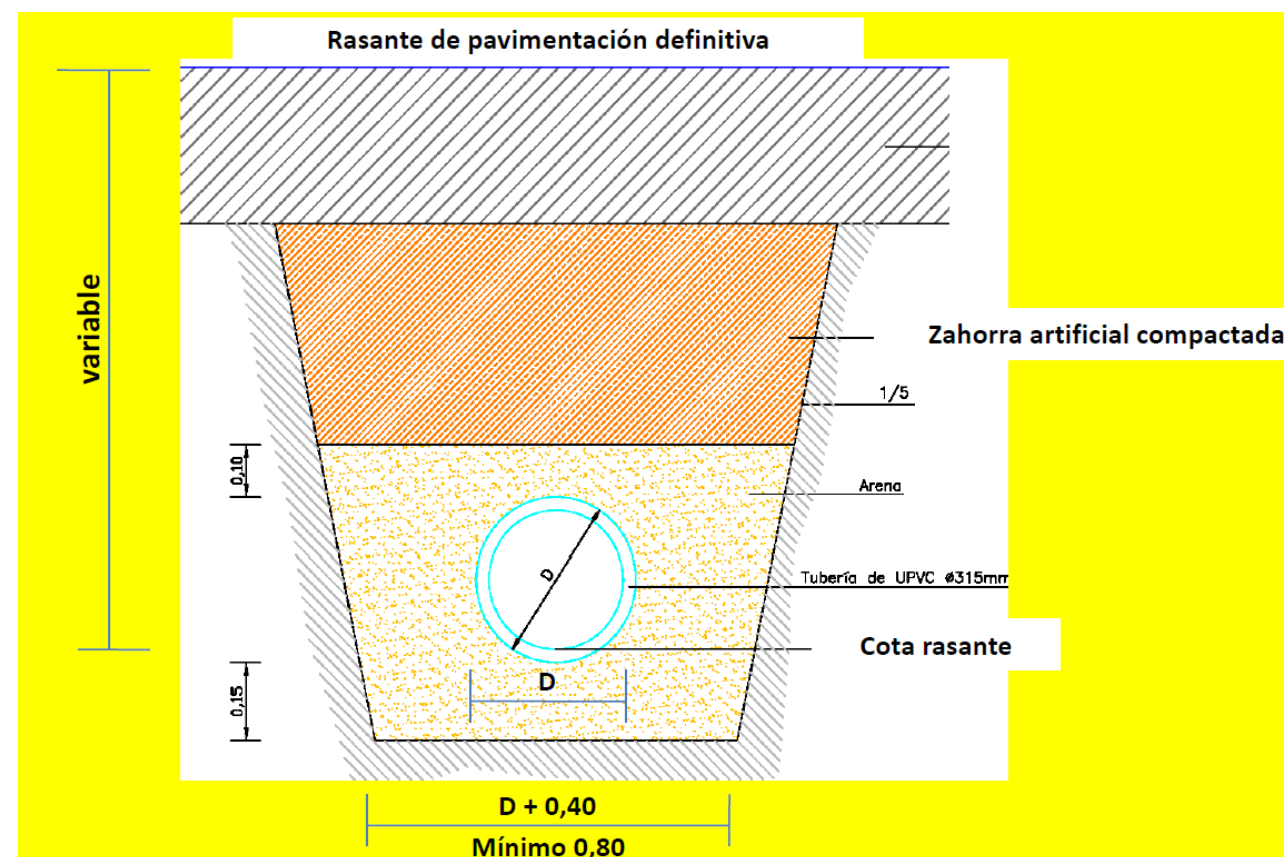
Sección tipo zanja con rasante de pavimentación definida
